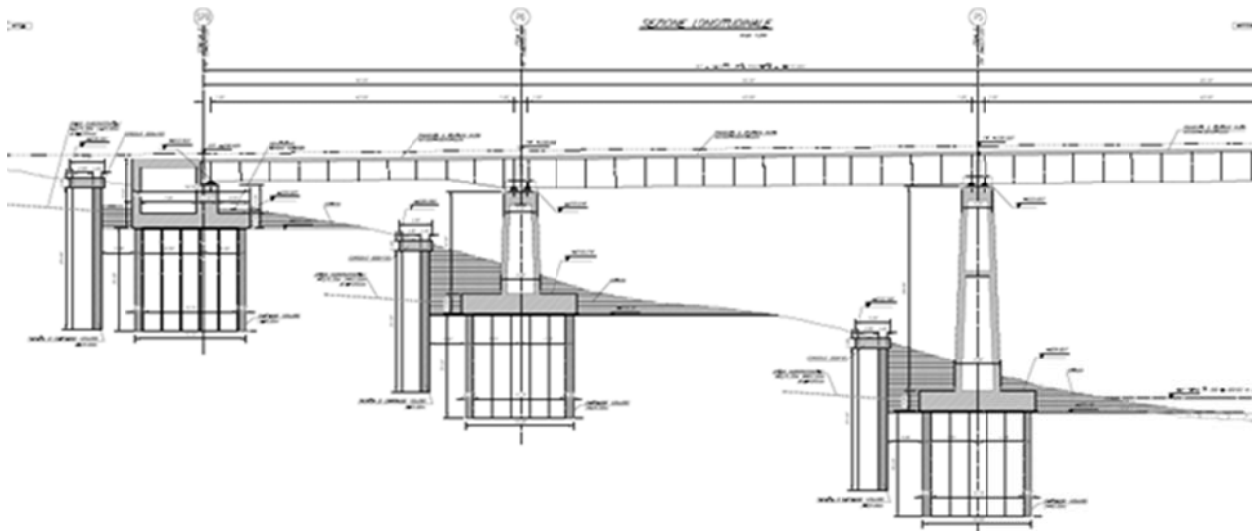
Sezione longitudinale di viadotto Ufita - Rocchetta
